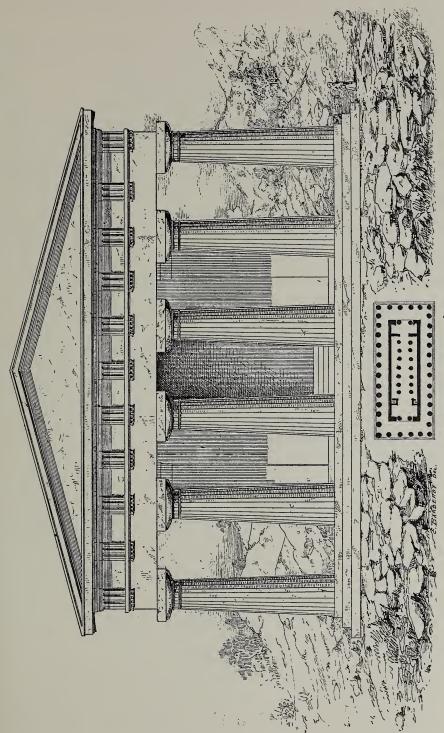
, 131. — Temple de Pæstum. Élèvation et plan.
